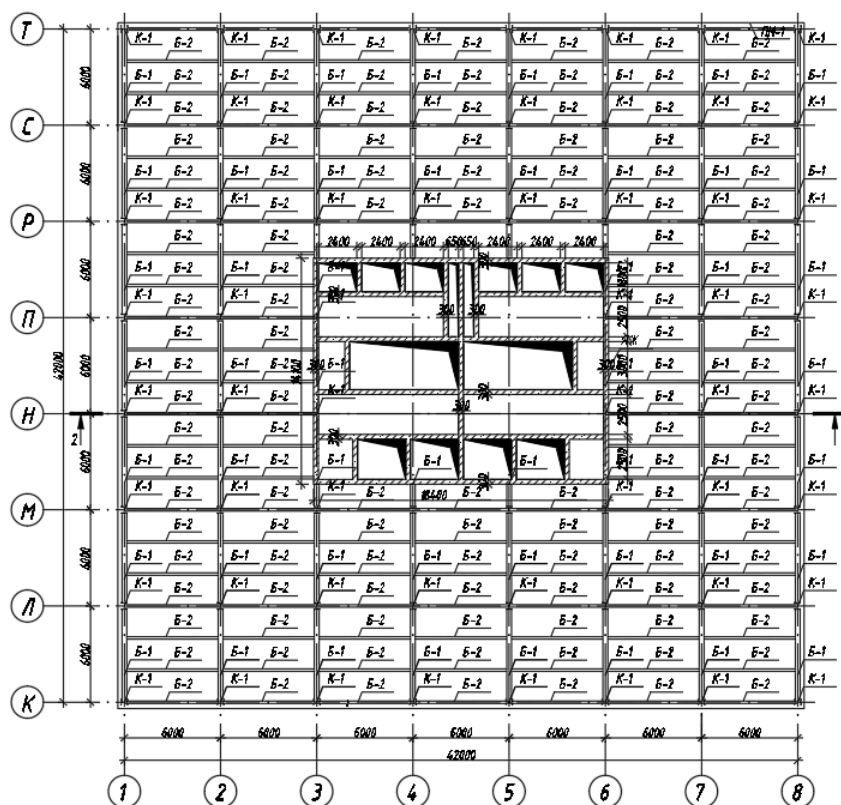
Схема расположения несущих элементов металлического каркаса здания
